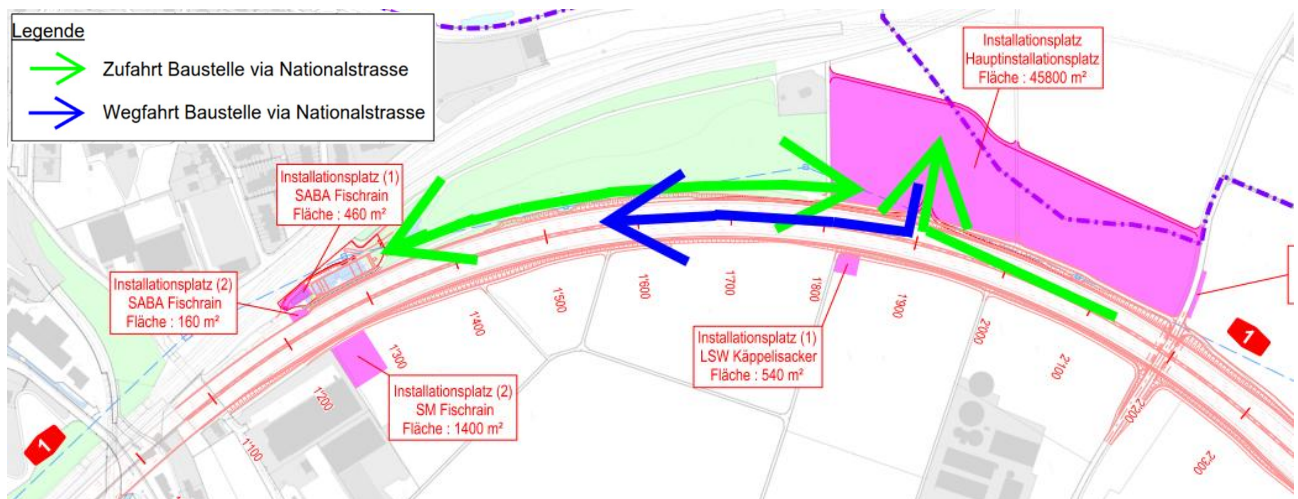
Erschliessung Baustelle SABA Fischrain / Hauptinstallationsplatz
